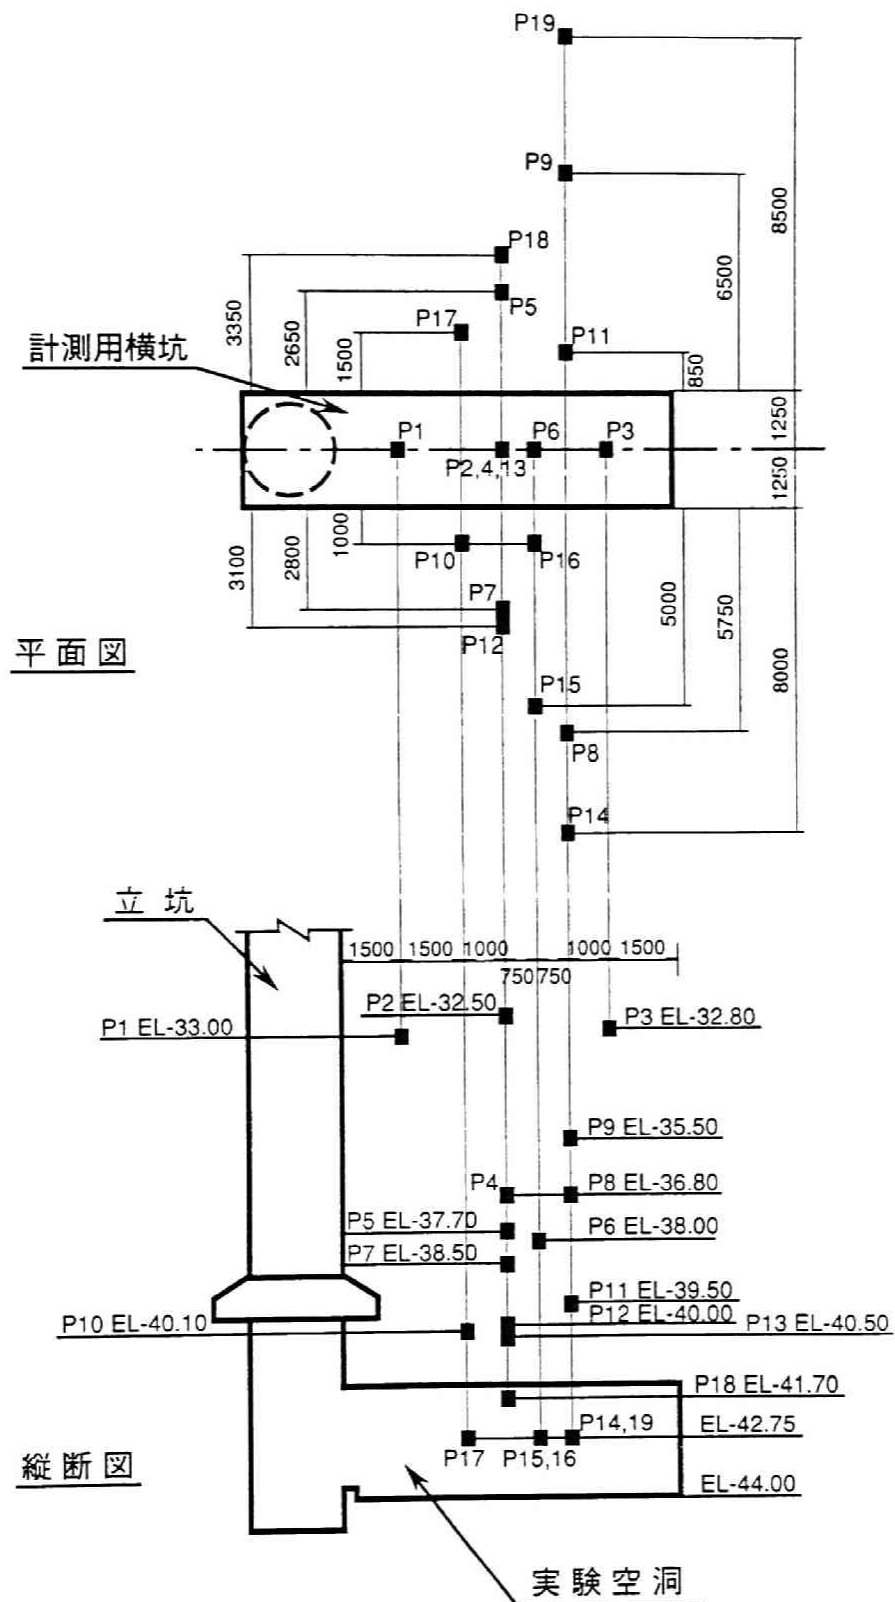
2. 3 間隙水圧計配置図 (平面図、縦断面図)
